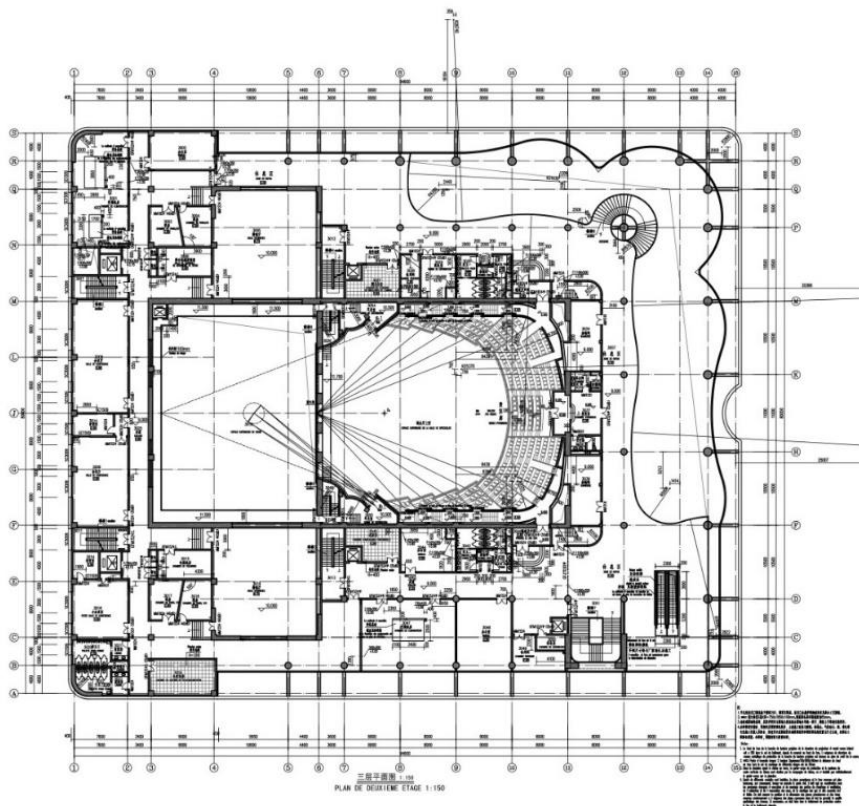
Plan du 2^e niveau de l'opéra d'Alger.
